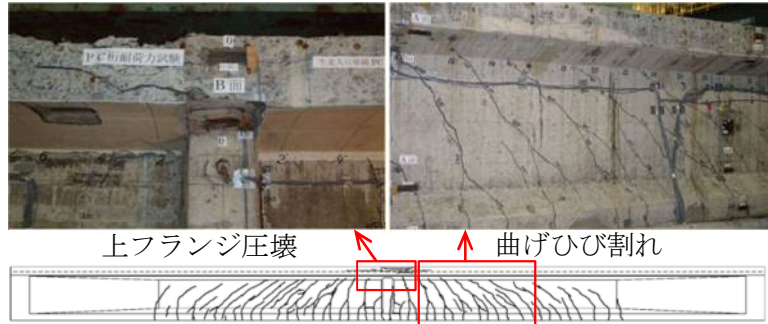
破壊時のひび割れ発生状況 (静的荷重試験)
